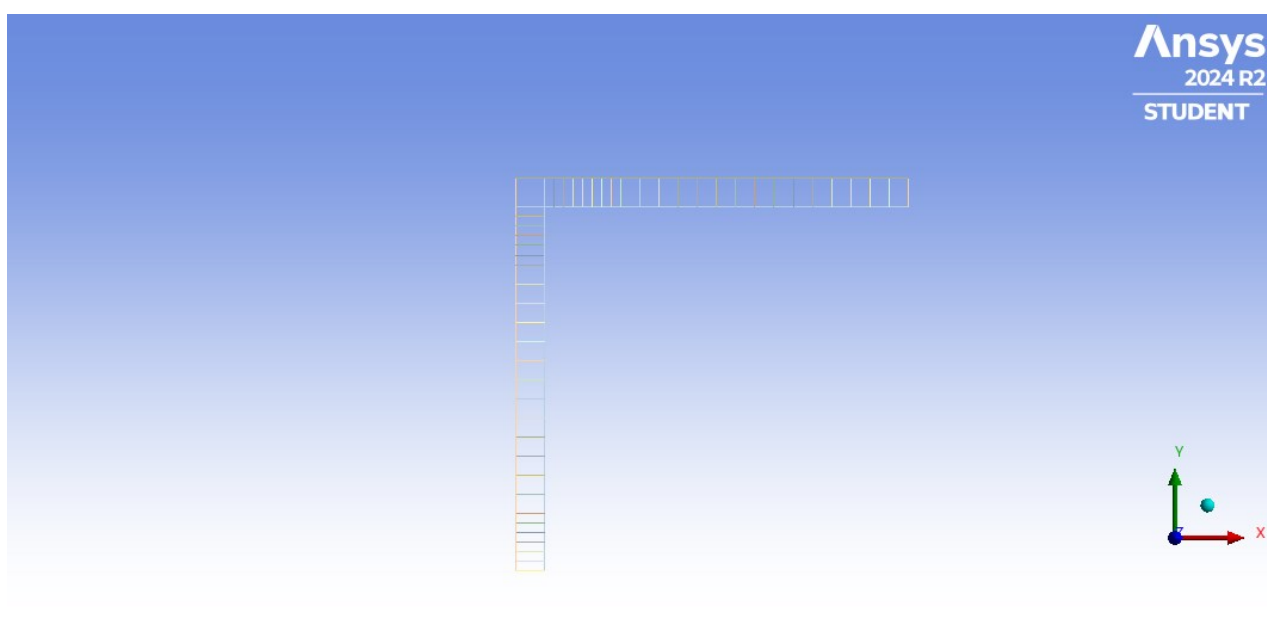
Vista frontale delle barre longitudinali e staffe (linee)
